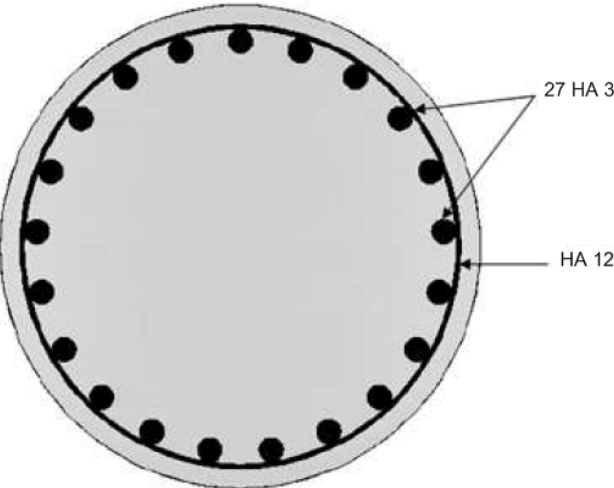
Ferrailage du pieu de la culée (coupe transversale)
